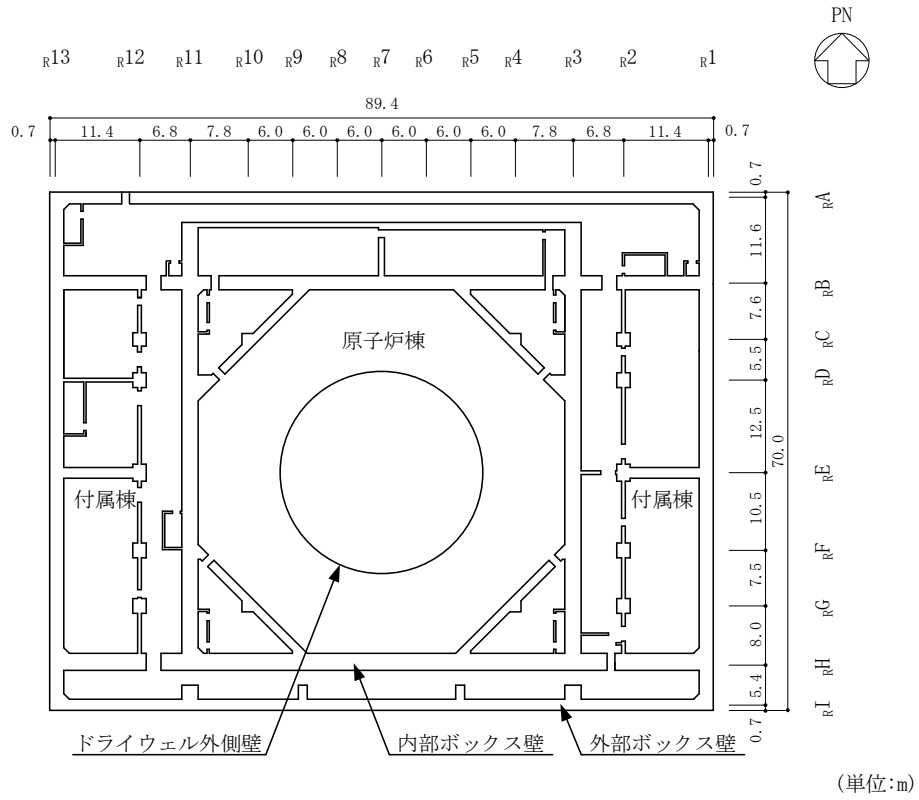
(1) 原子炉建物の概略平面図 (EL 1.3m\*)
